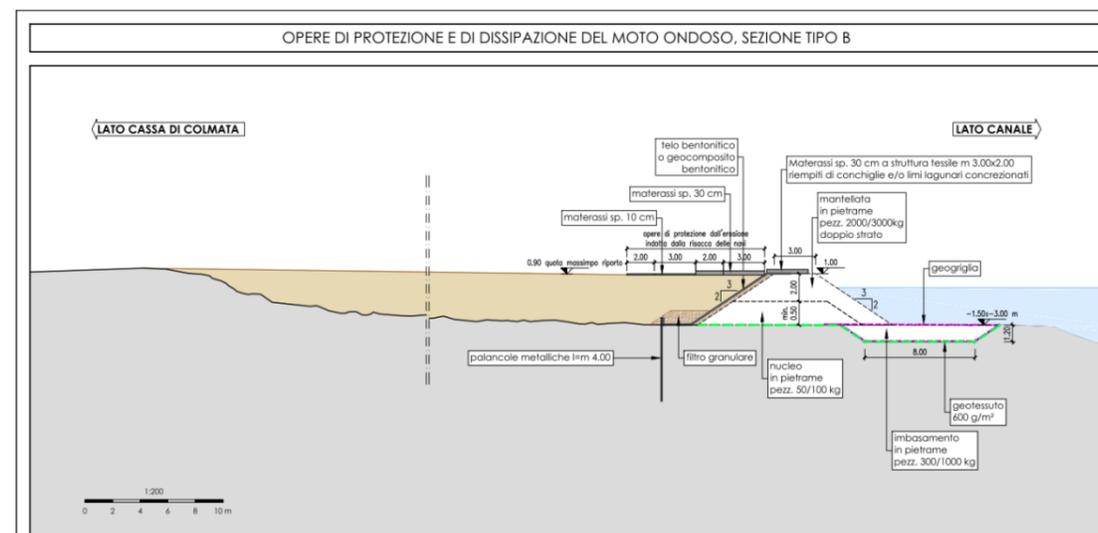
opere di protezione e dissipazione sezione tipo B
